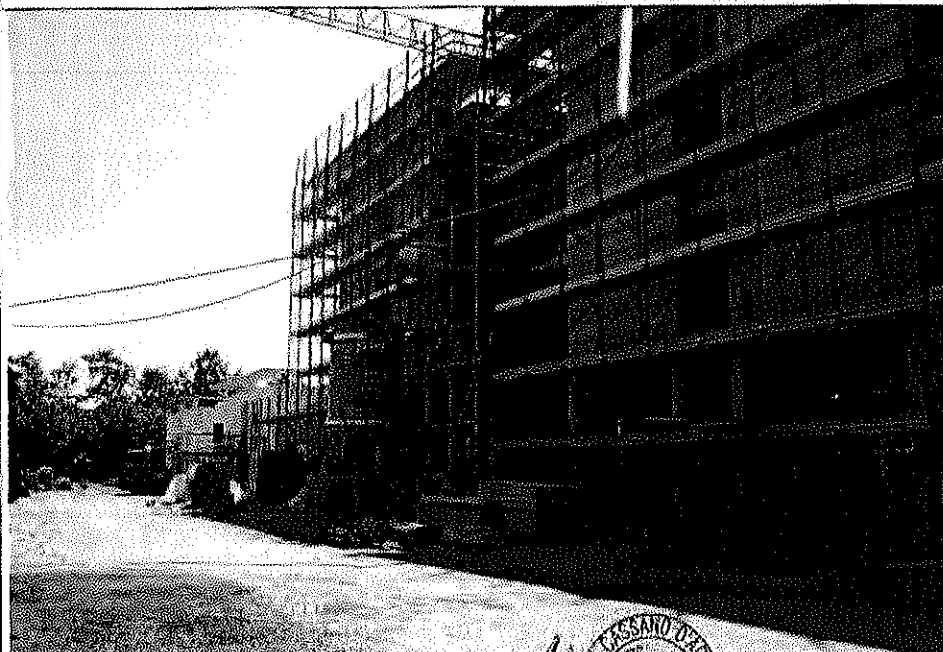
Vista dell'hotel, composto da un piano interrato e n. 4 piani fuori terra.
